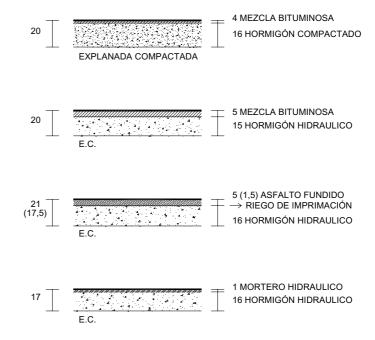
SECCIONES DE FIRME PARA SENDAS BICI (cotas en cm)
